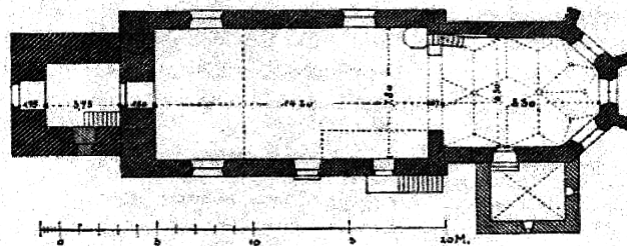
Steinfurth. Grundriss der Kirche.
